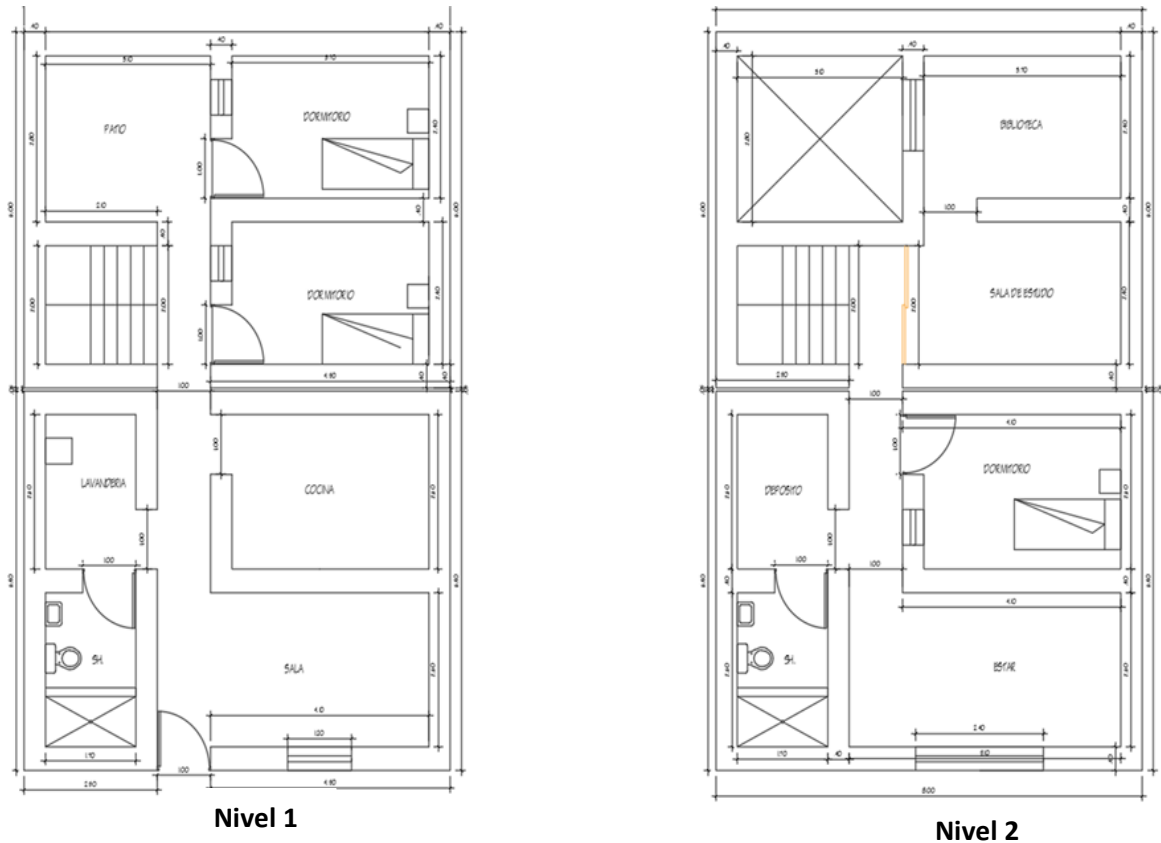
Plano en planta del prototipo de vivienda con junta sísmica y con refuerzo de geomalla. Fuente: Elaboración Propia, 2019
